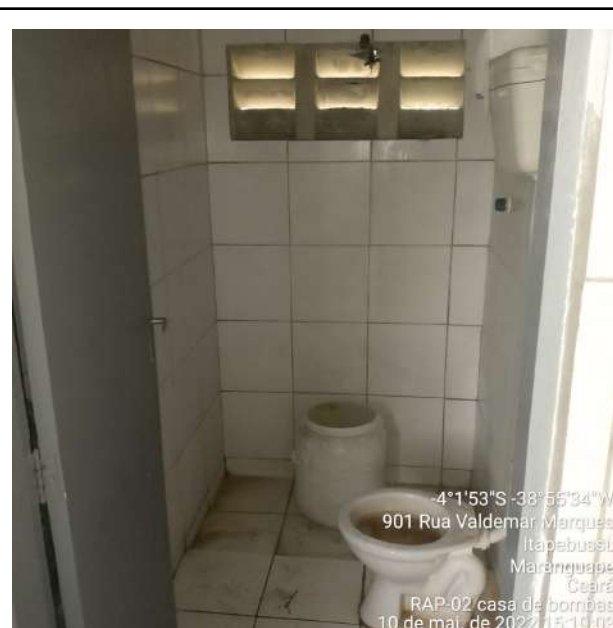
RAP-02: banheiro da casa de apoio sem manutenção e limpeza.
